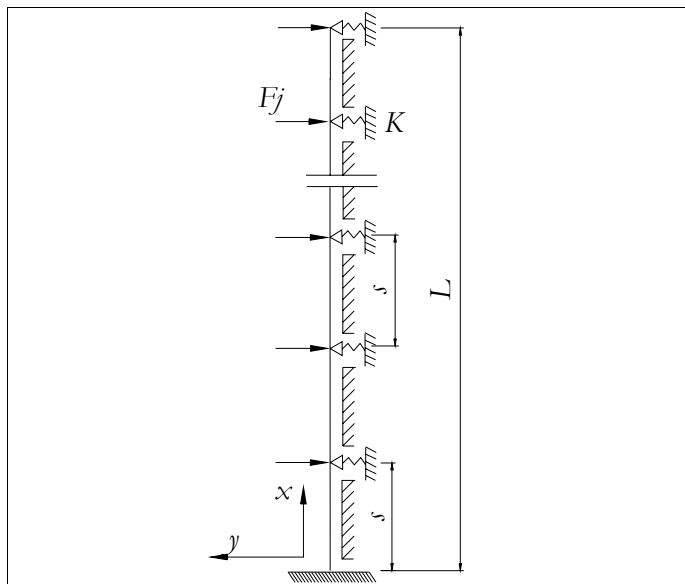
Modelo para consideração das emendas das barras da armadura.
